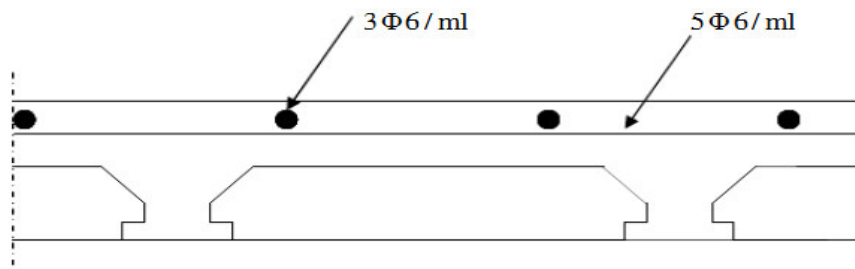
Schéma de ferrailage de la dalle de compression.
